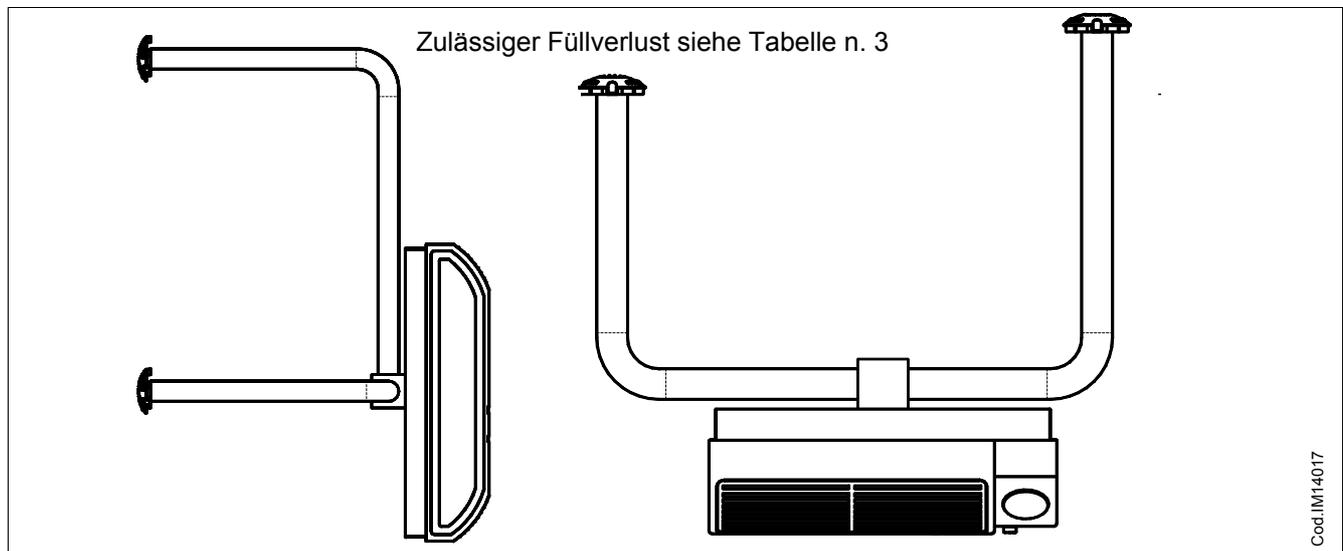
INSTALLATION MIT GETRENNTEN ROHREN
